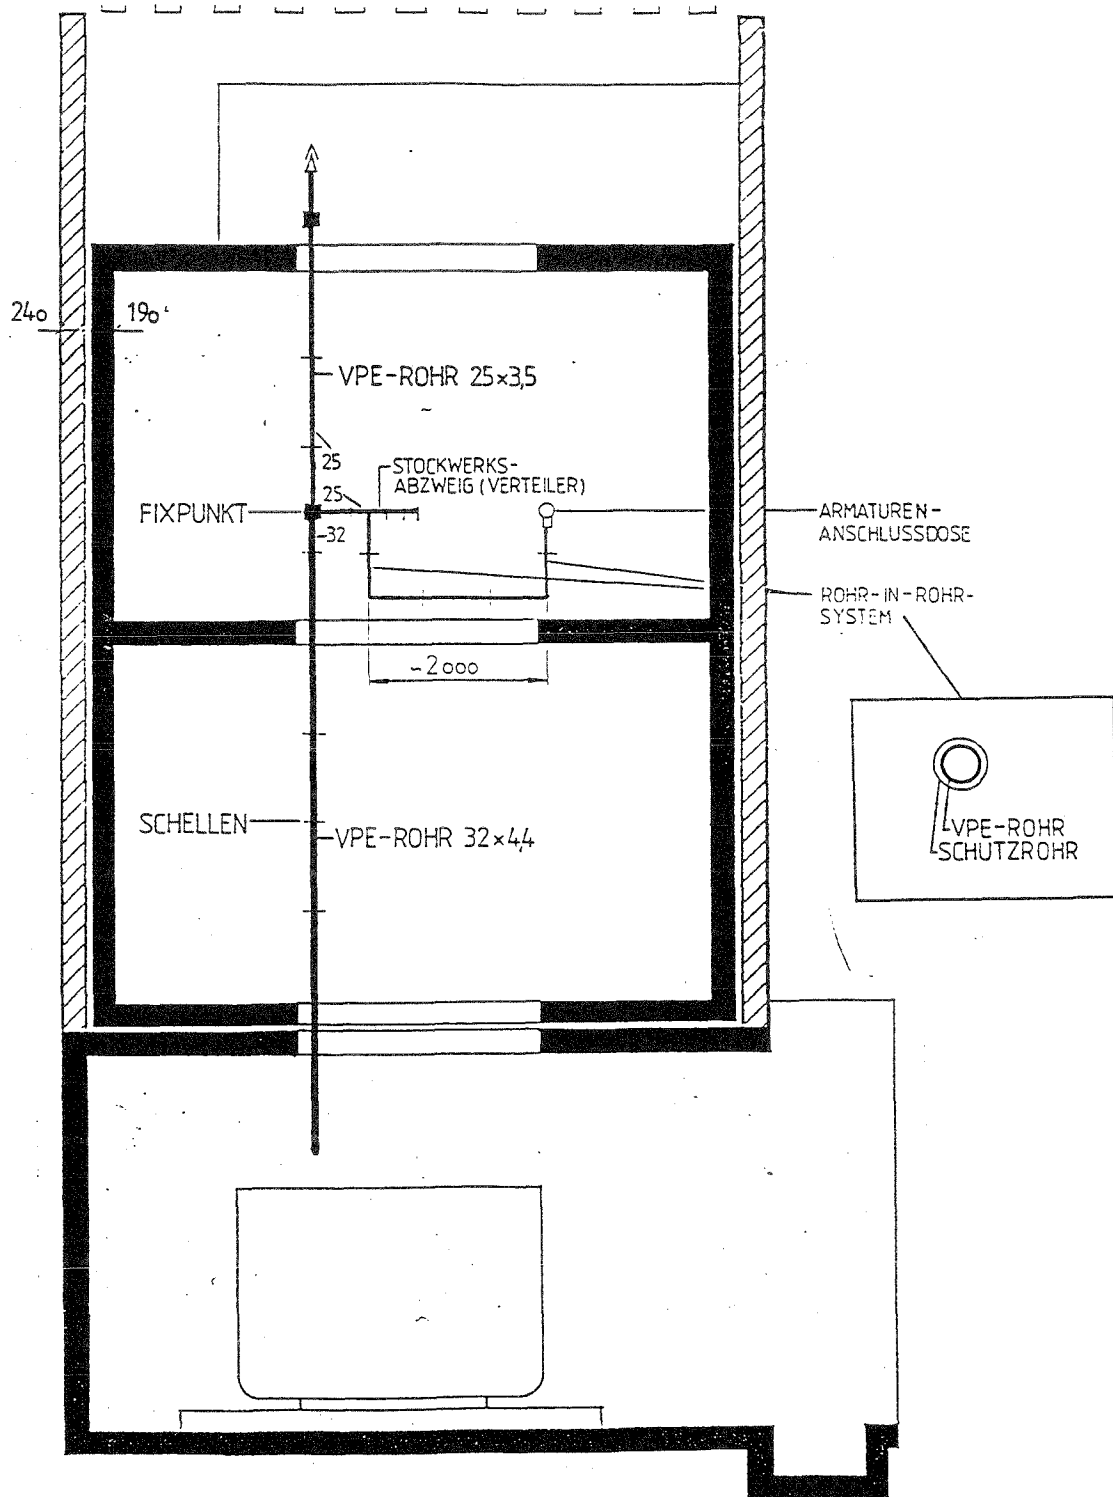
Musterinstallation im Installationsprüfstand für Rohr-in-Rohr-System
